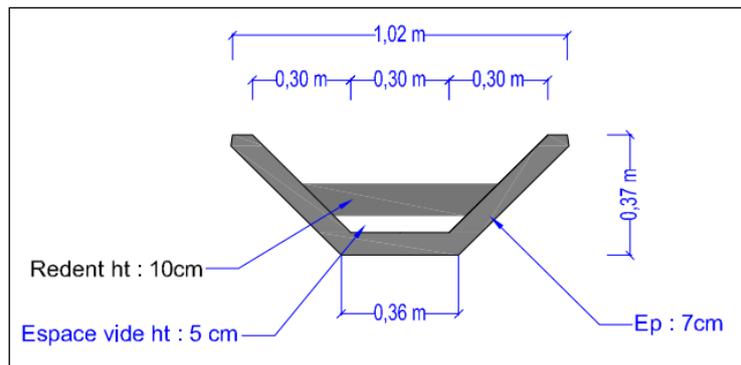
Extrait du plan de masse - Coupe type vue de face d'un caniveau béton trapézoïdal à redents
